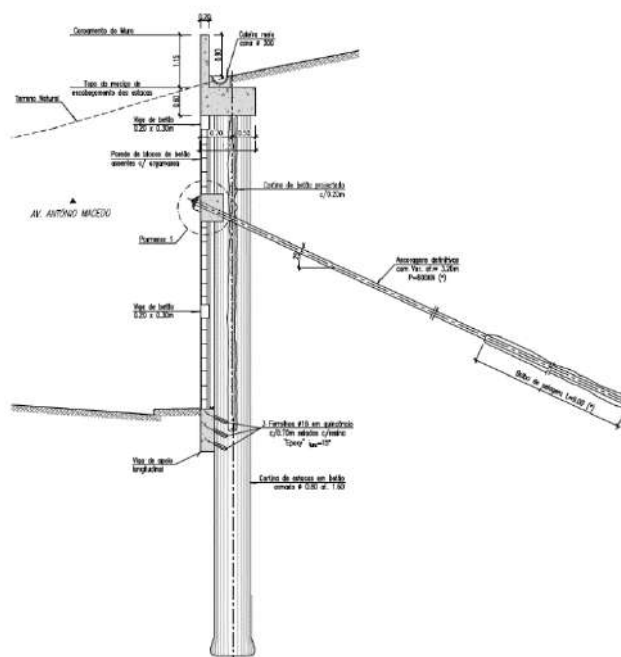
Muro M3 - Pormenor das paredes de contenção na zona ancorada.
